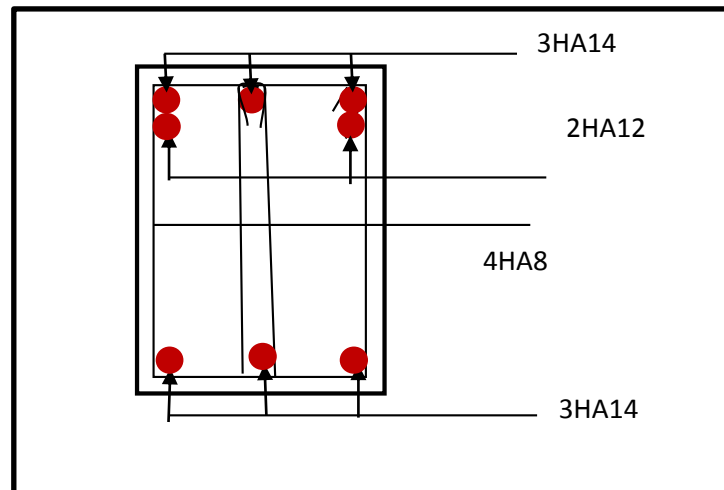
Ferrailage en travée d'une poutre secondaire.
